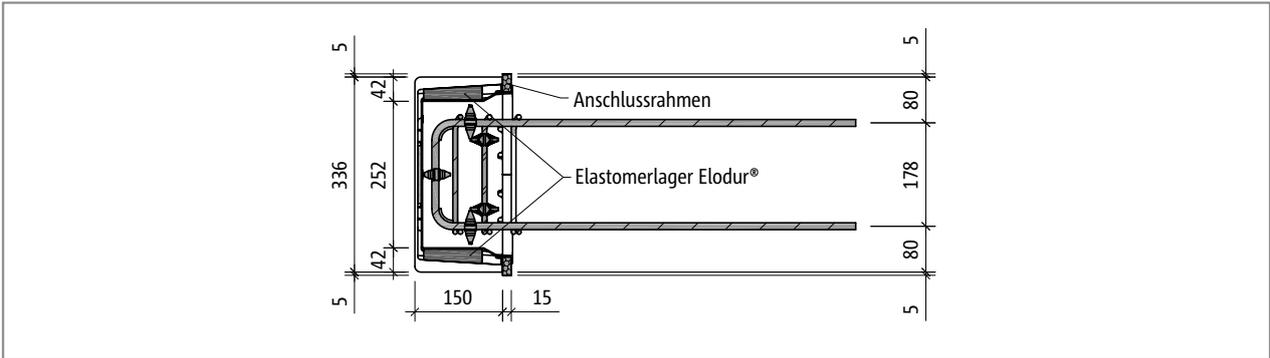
Schöck Tronsole® Typ Z-VH+VH-T: Horizontalschnitt
